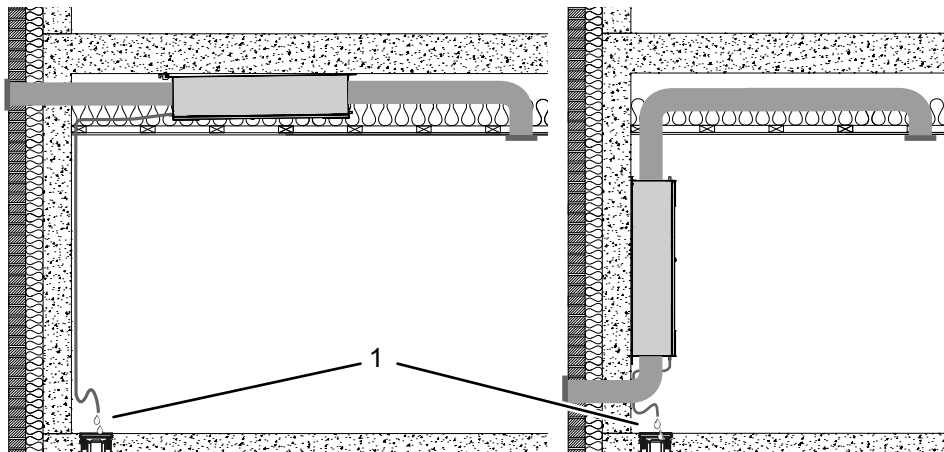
montage en faux plafond (à gauche) et montage au mur (à droite) avec tuyau d'écoulement des condensats
